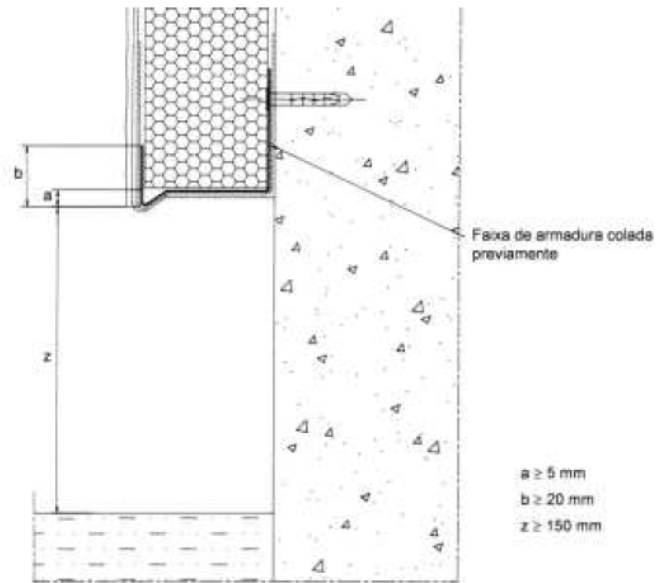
Aplicação do ETICS – Emendas da armadura [7]
